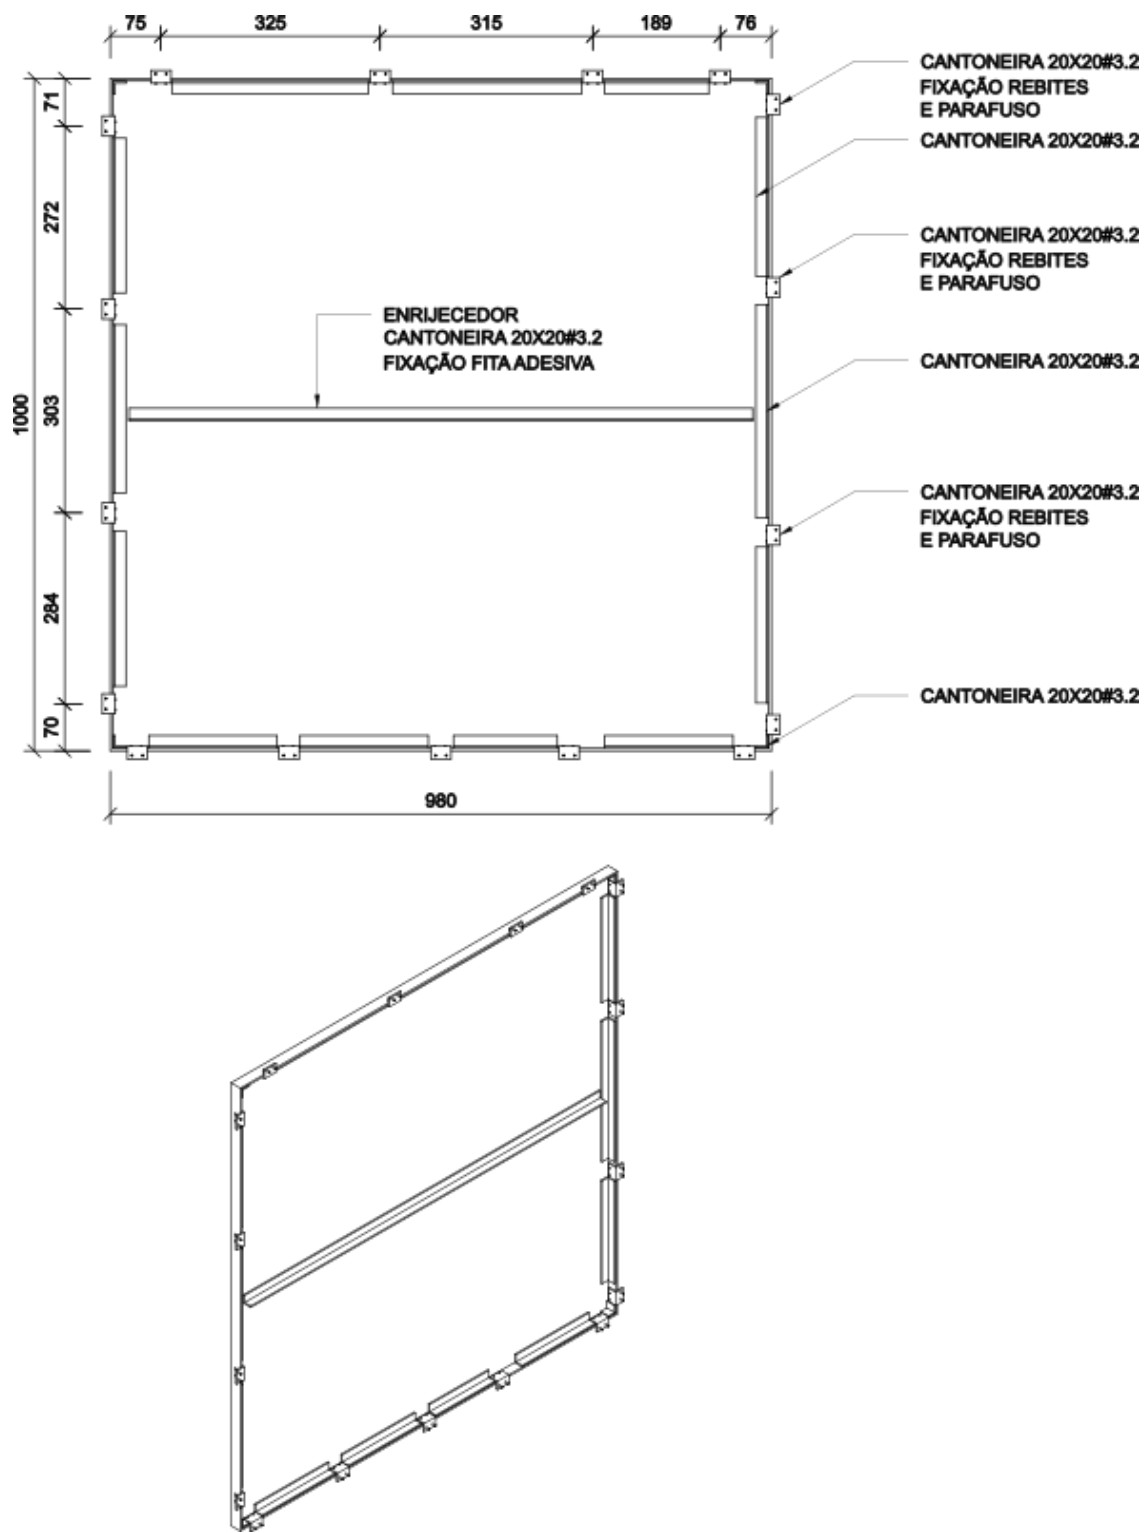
Detalhes dos painéis de ACM situados nas regiões centrais das faces das torres das fachadas frontal e posterior.
